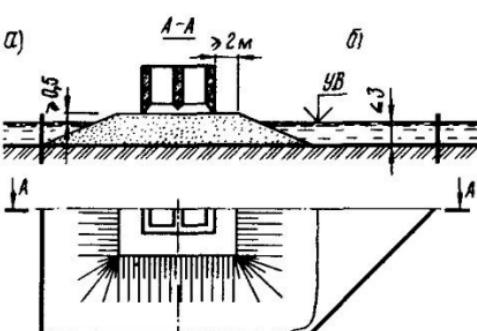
Островок с ограждением, не воспринимающим давление грунта
